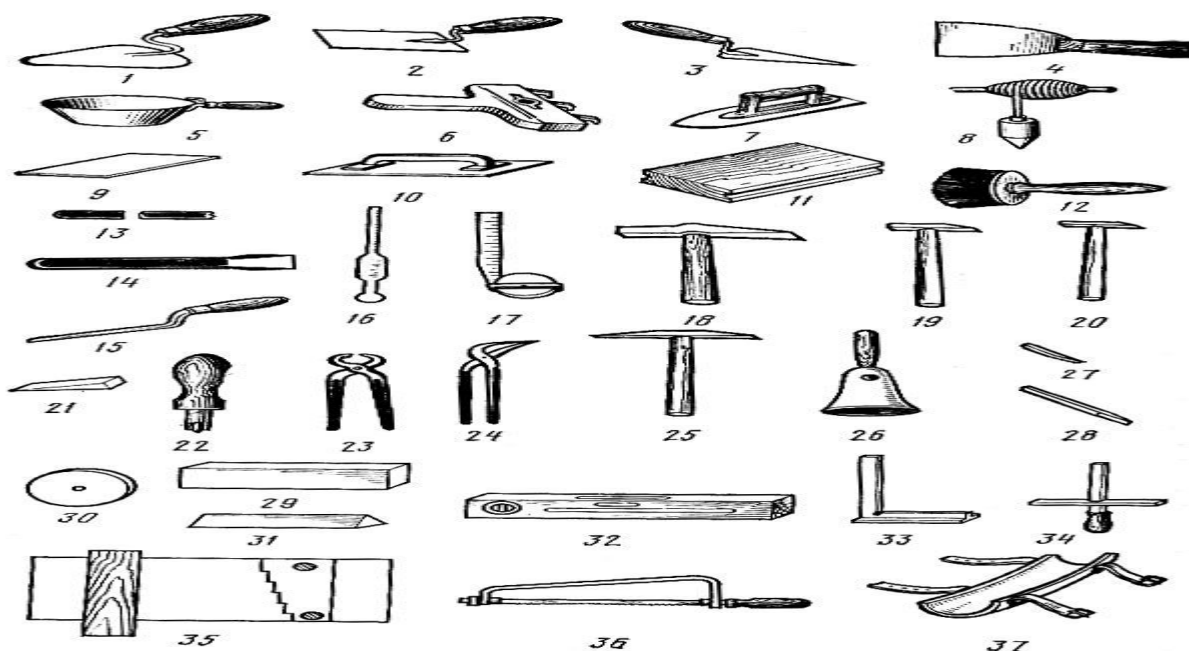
Ручной инструмент облицовщика: 1 - обыкновенная лопатка, 2 - прямоугольная лопатка, 3 - отрезовка, 4 - стальной шпатель, 5 - штукатурный ковш, 6 - царапка, 7 - гладилка, 8 - отвес массой 150 г, 9 - резиновый
